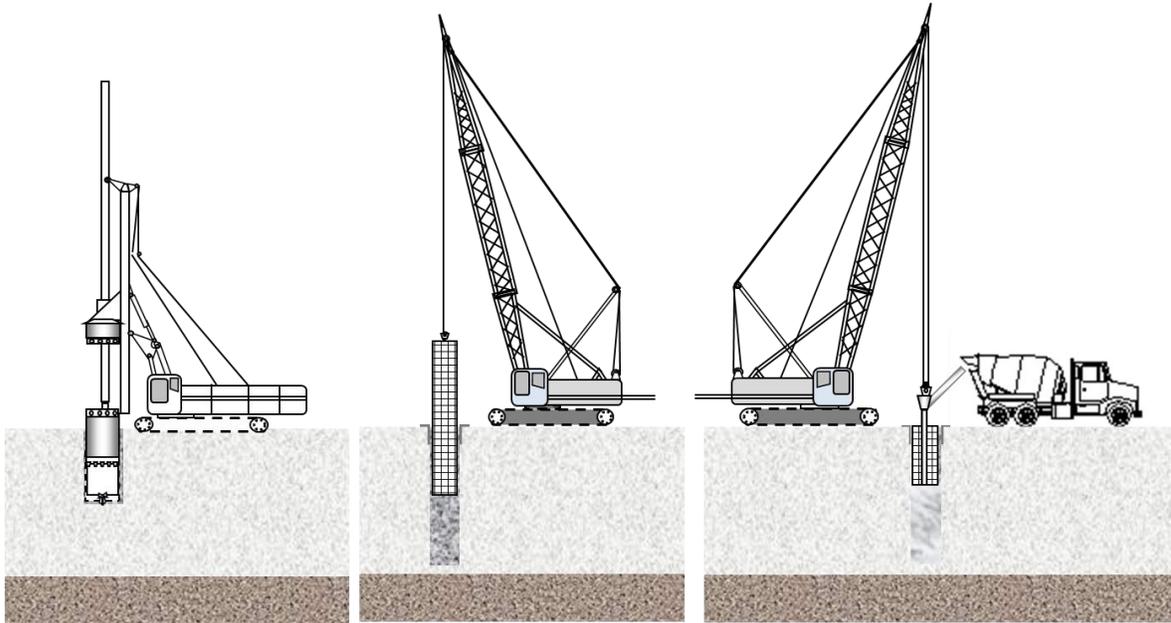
; Se muestra la perforación colocación del acero y colado de las pilas y la excavación, colocado del armado y colado del cajón de cimentación.
